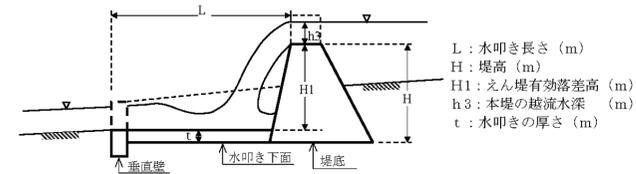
水叩き長さおよび水叩き厚さ（経験式の場合）
